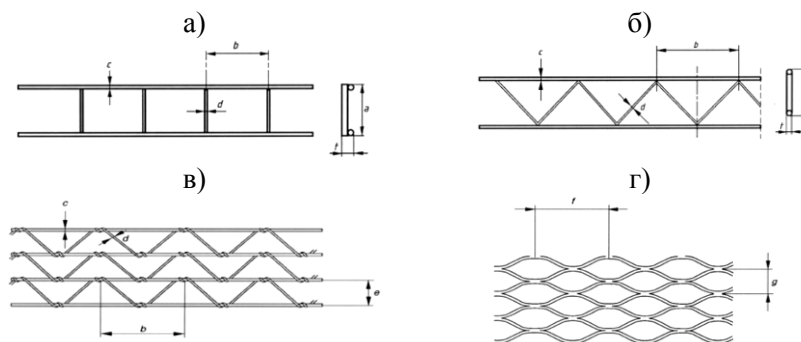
Примеры арматурных изделий применяемых для армирования горизонтальных швов каменной кладки: а, б – сварные сетки, в – плетенная сетка, г – просечно-вытяжная сетка
